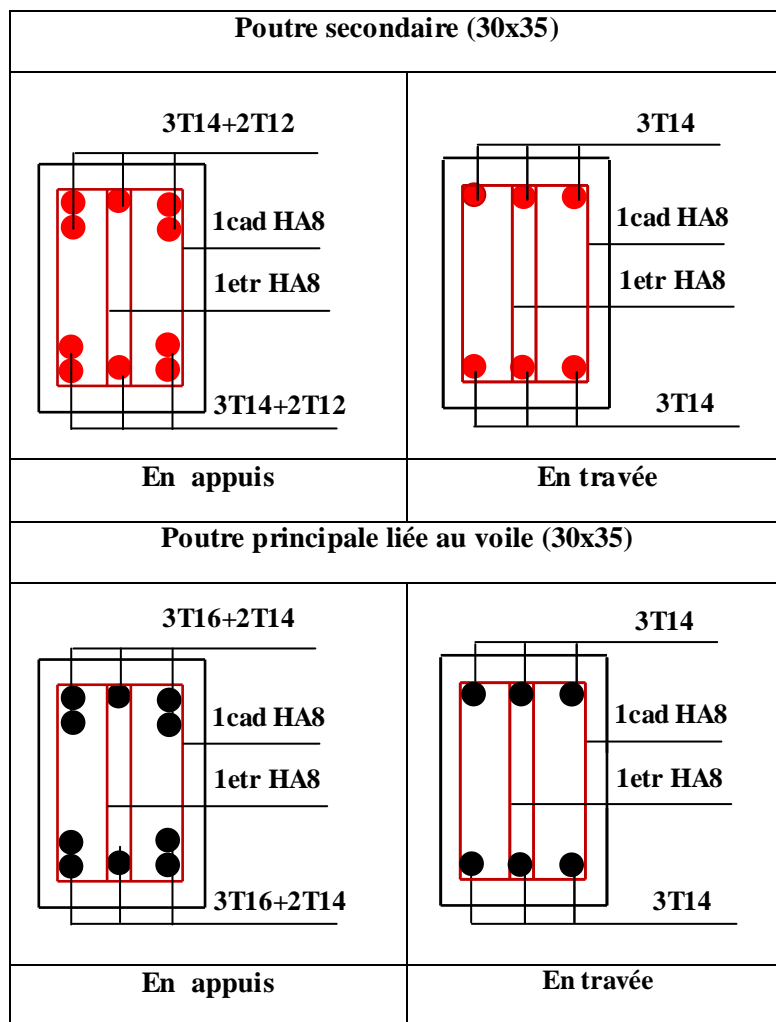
Shéma de ferrailage des poutres secondaires
